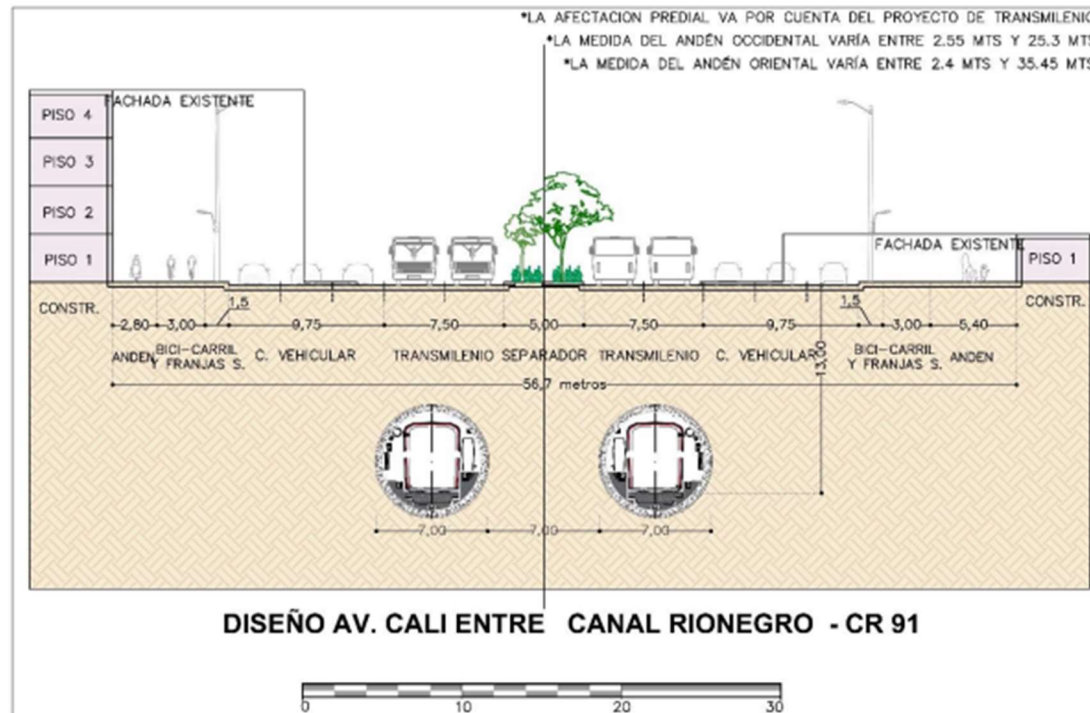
Perfil vial definido para Av. Cali (entre Canal Rionegro y cra. 91).
